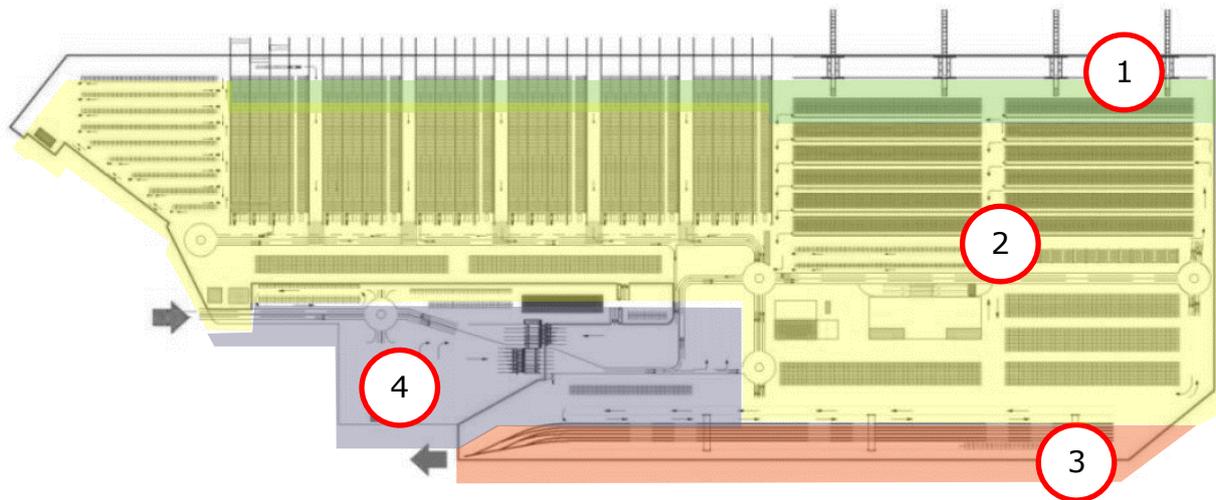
Layout progettuale del progetto approvato nel 2013 – Terminale container Onshore
